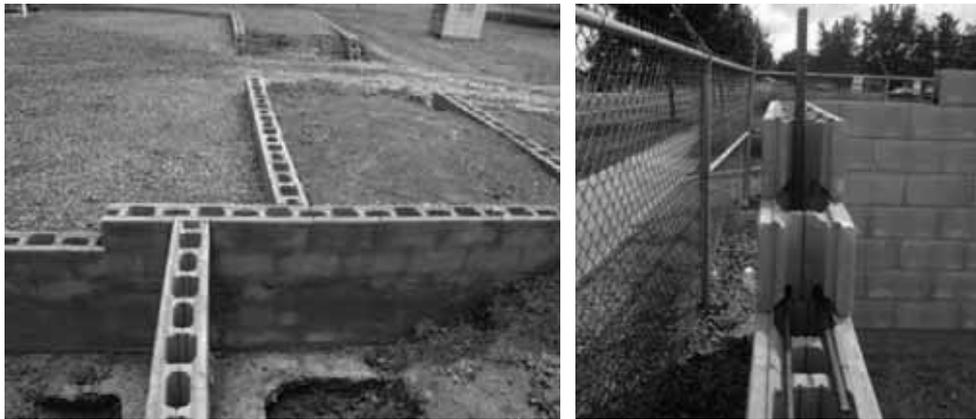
Puesta en obra del bloque para macizado Azar block.
